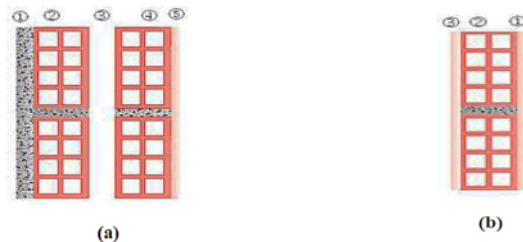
Coupe verticale d'un mur extérieur et d'un mur intérieur
